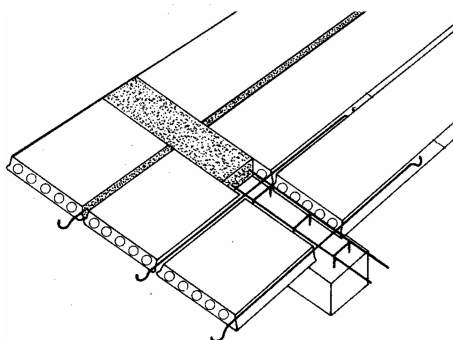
Exemplo de ligação laje-viga através de laje alveolar com amarração. Adaptado de [1].
